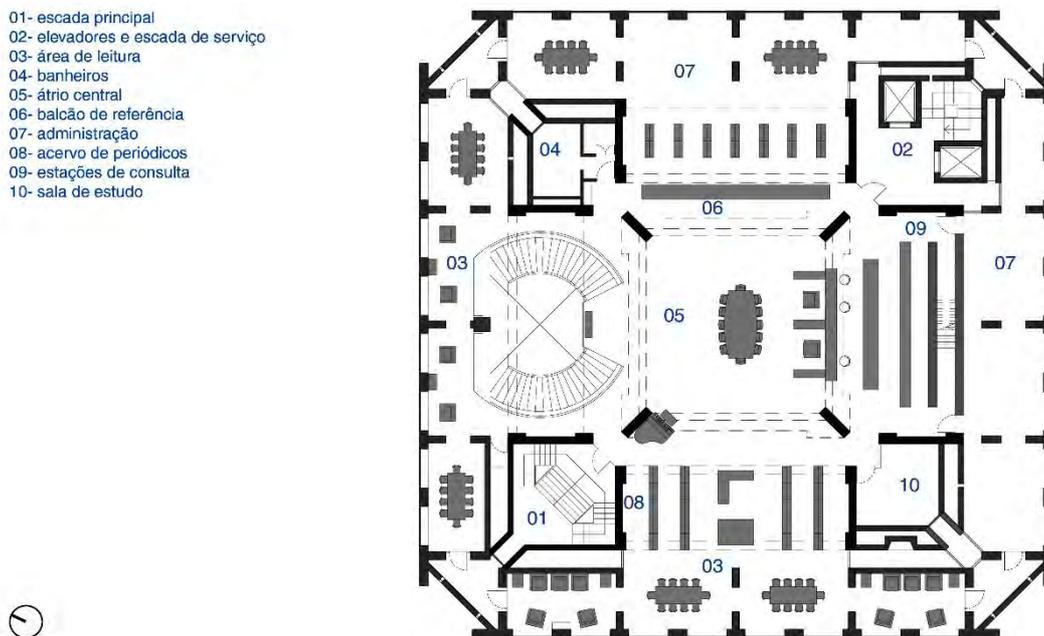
| Planta do segundo pavimento (ÁTRIO) [redesenho do autor]
